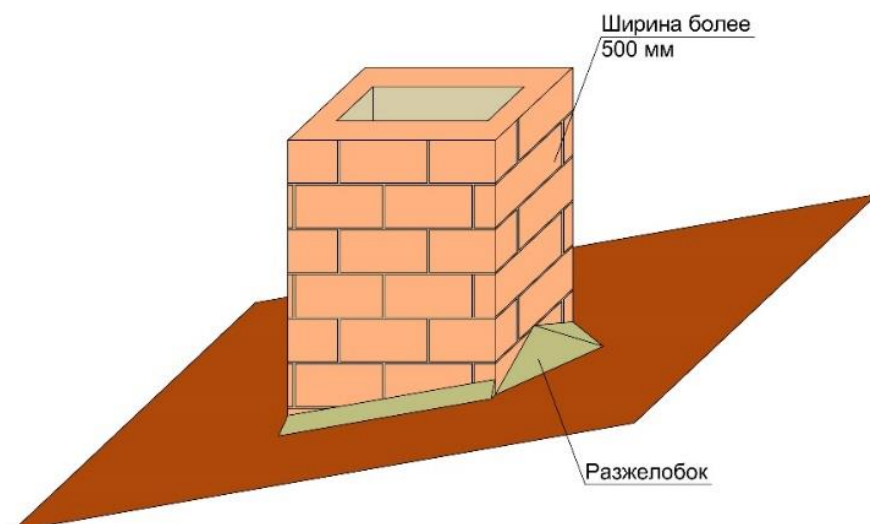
Примыкание кровли к трубе дымохода шириной более 500 мм
